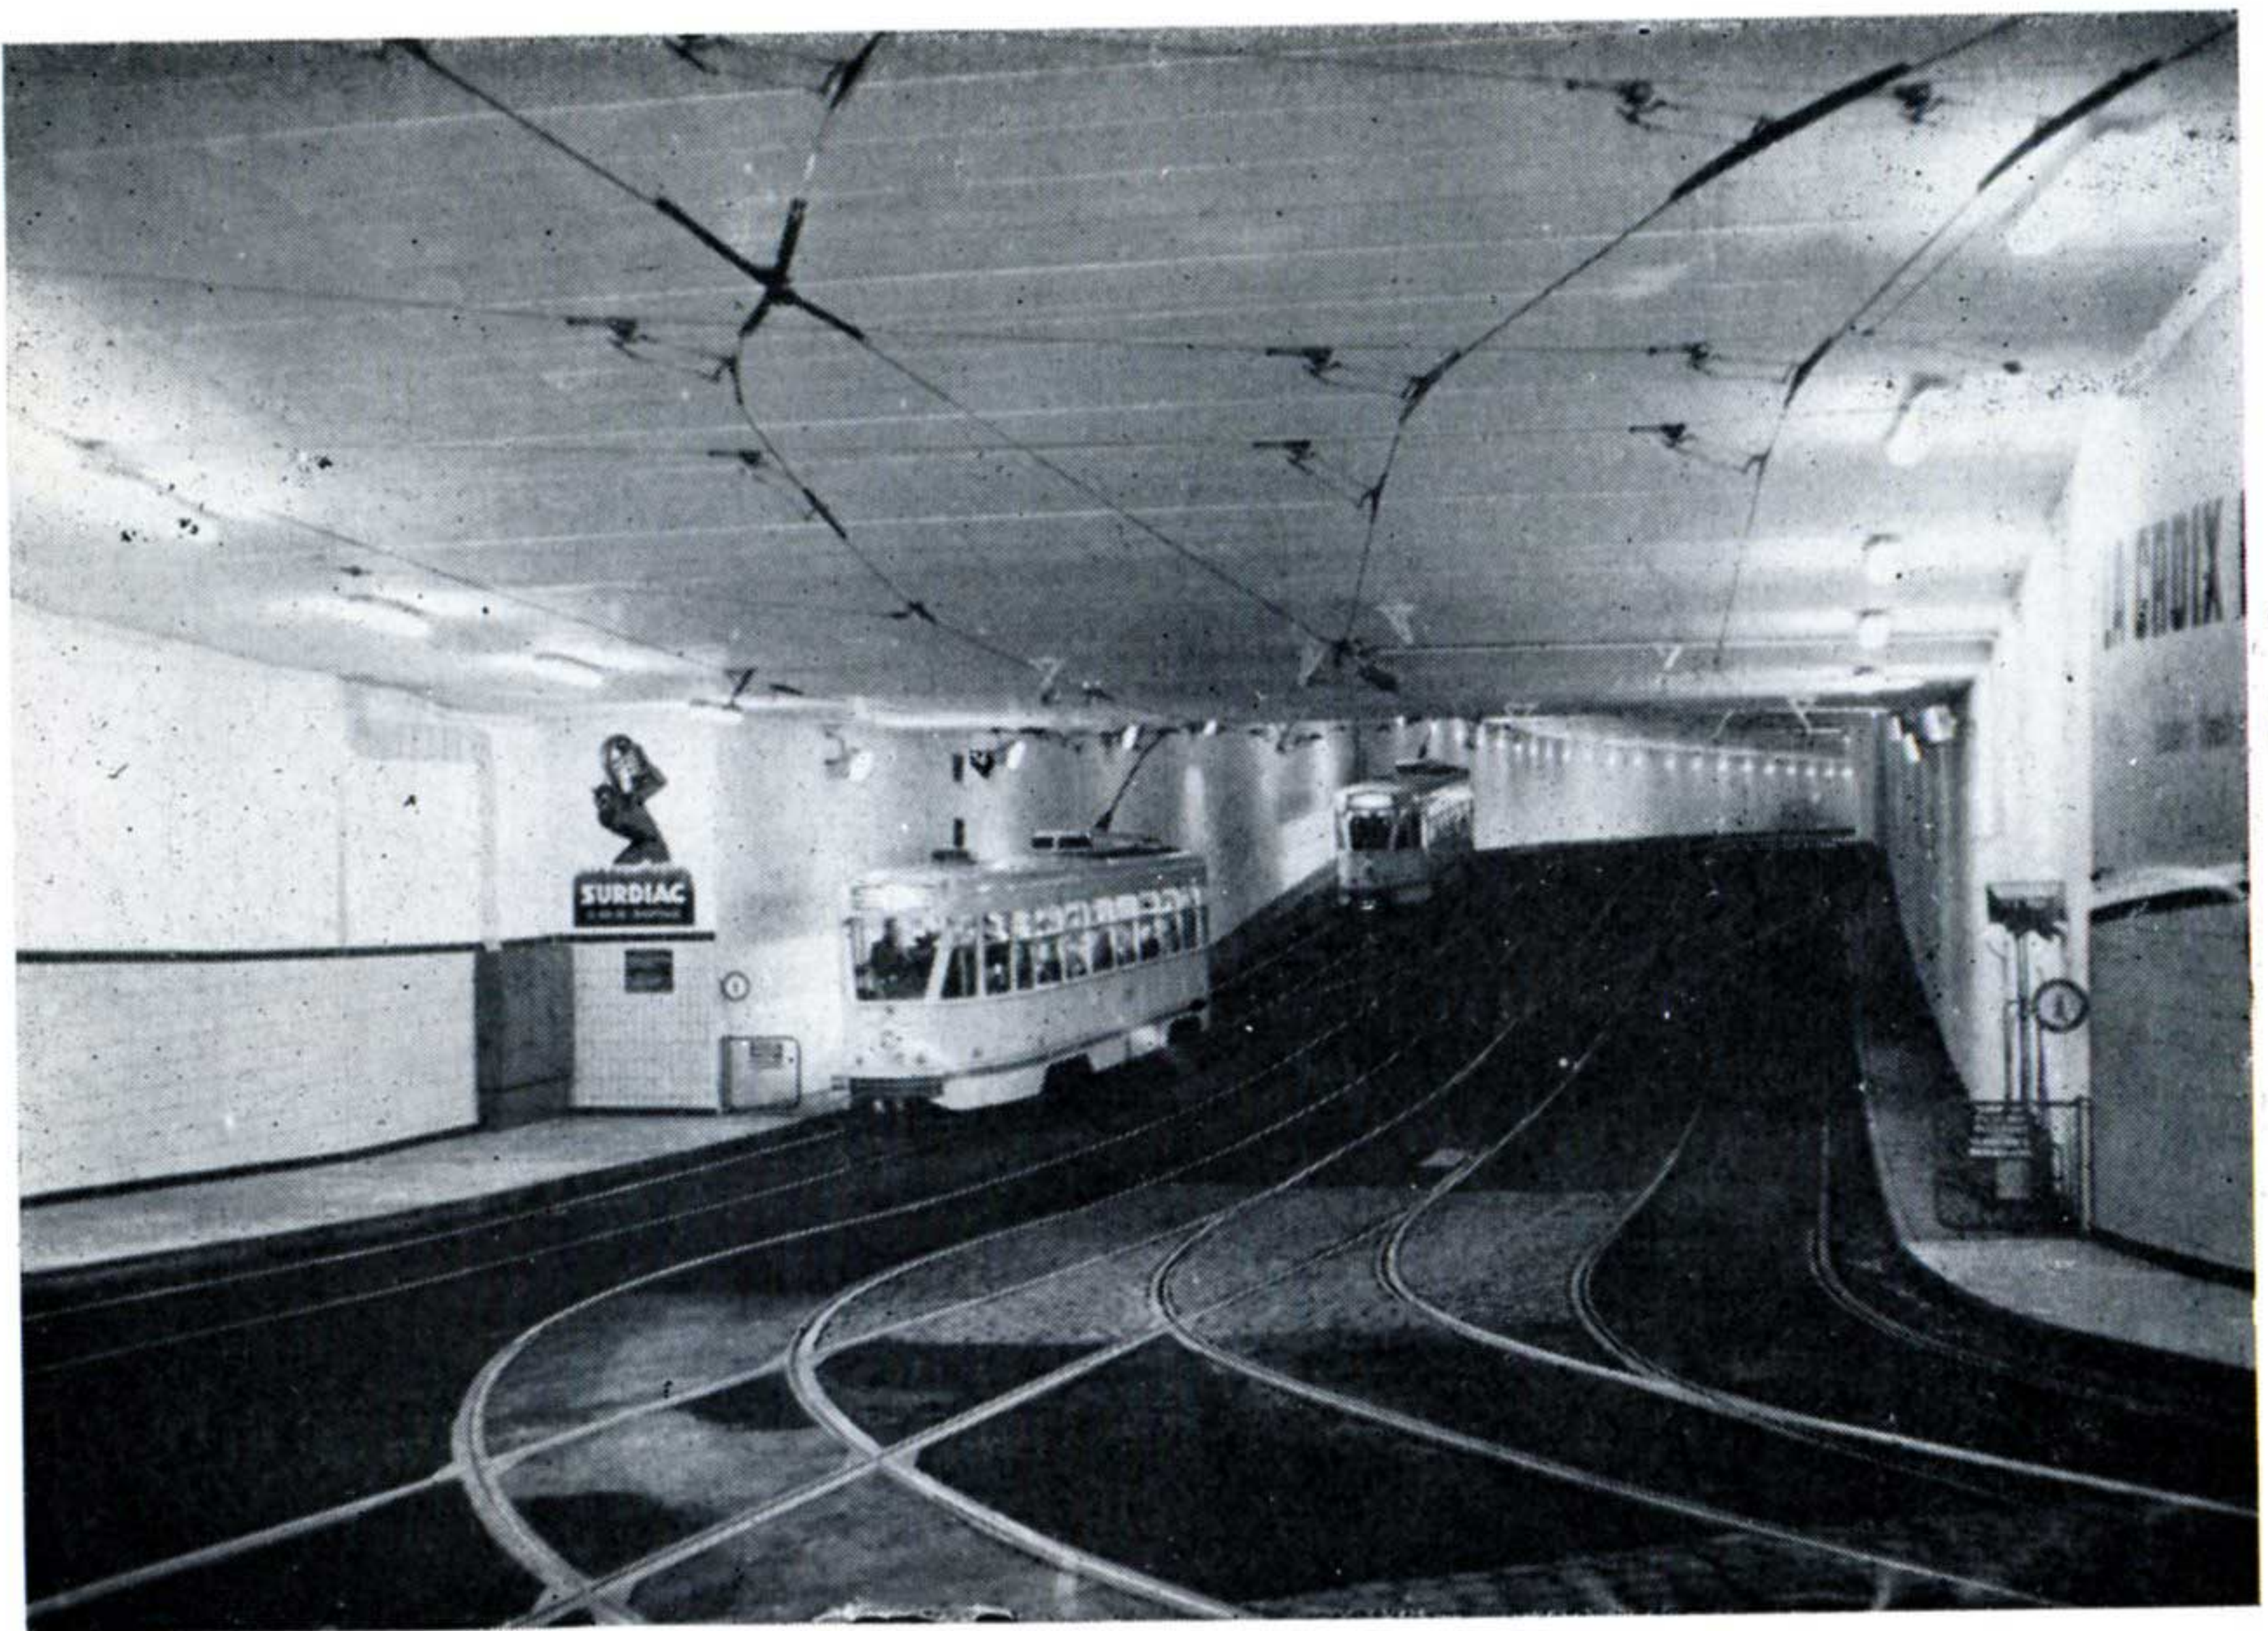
la rampe Lemonnier vue vers le centre de la ville.
